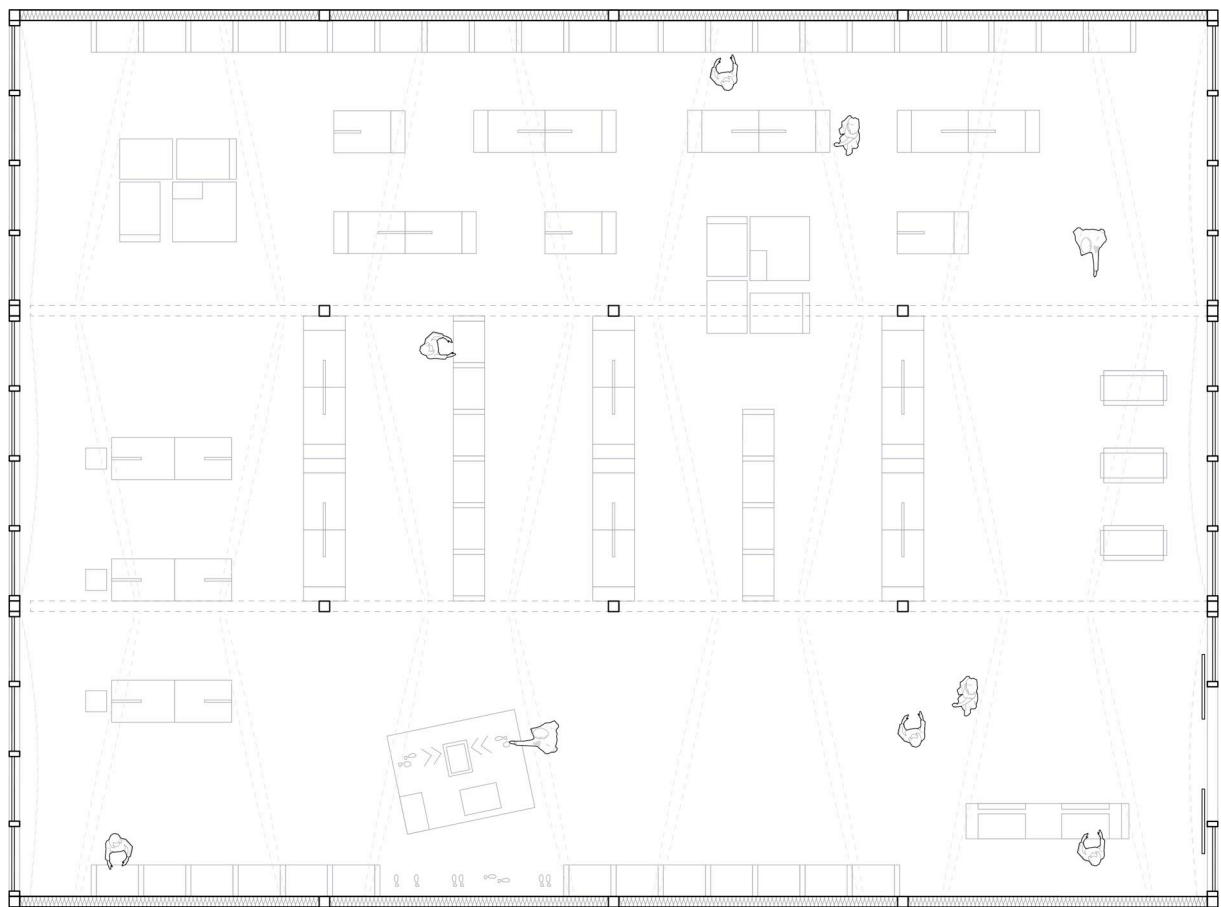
Grundriss Würth-Store mit Dachkonstruktion aus den U_1_A- bis U_6_A-Elementen, HTWG Konstanz
